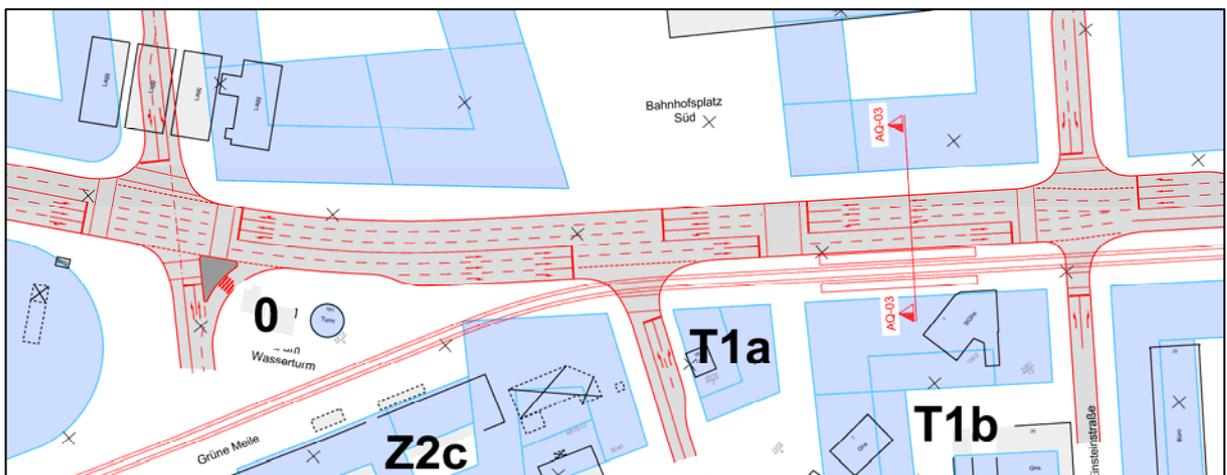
Lageplan Czernyring Bereich Mitte, Variante 2x2
